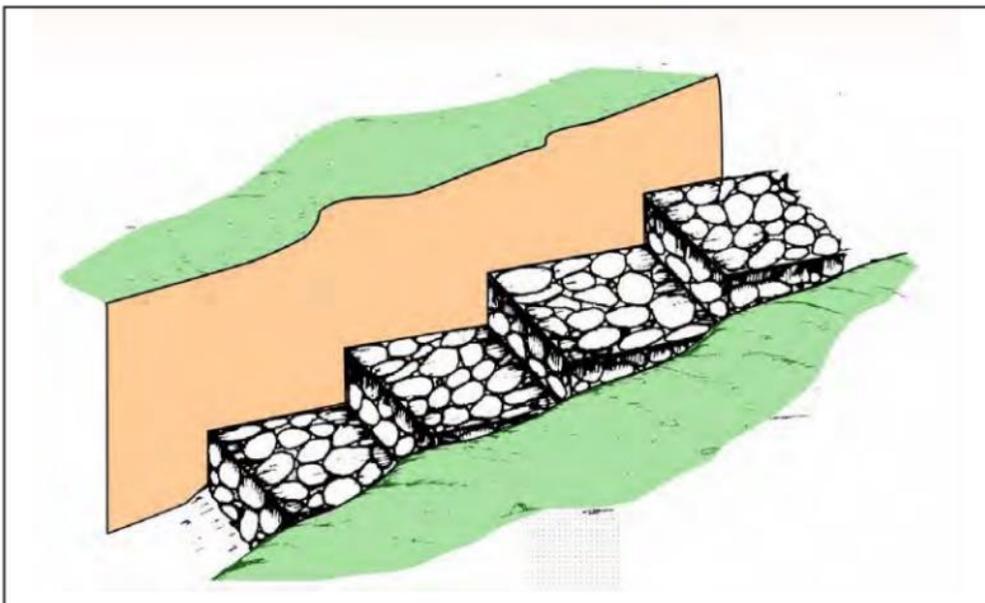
Protección del lecho de la quebrada con muros escalonados (andenes), utilizando bloques de roca o concreto armado.
